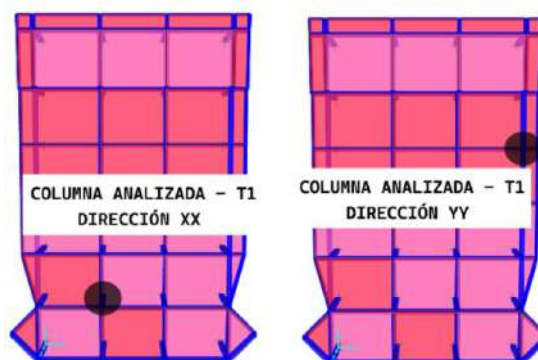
Bloque A: ubicación de las columnas para el cálculo de la rotación.
